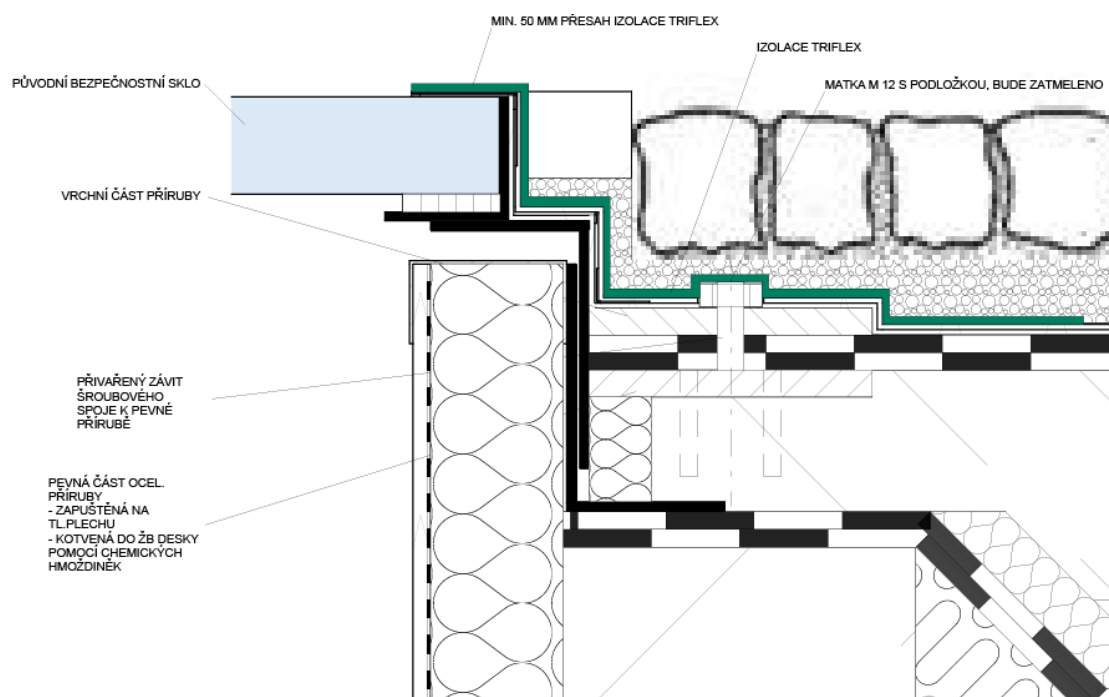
Technické schéma – sevření izolace mezi volnou a pevnou přírubu
